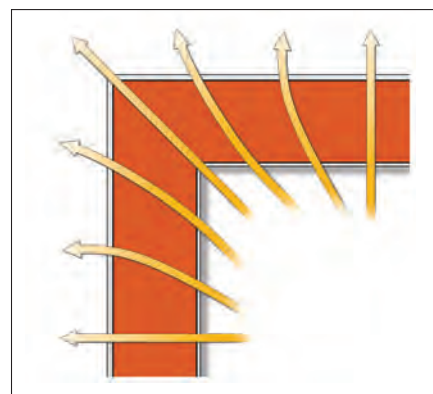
Wärmestromverlauf durch eine zweidimensionale, monolithische Außenwanddecke
